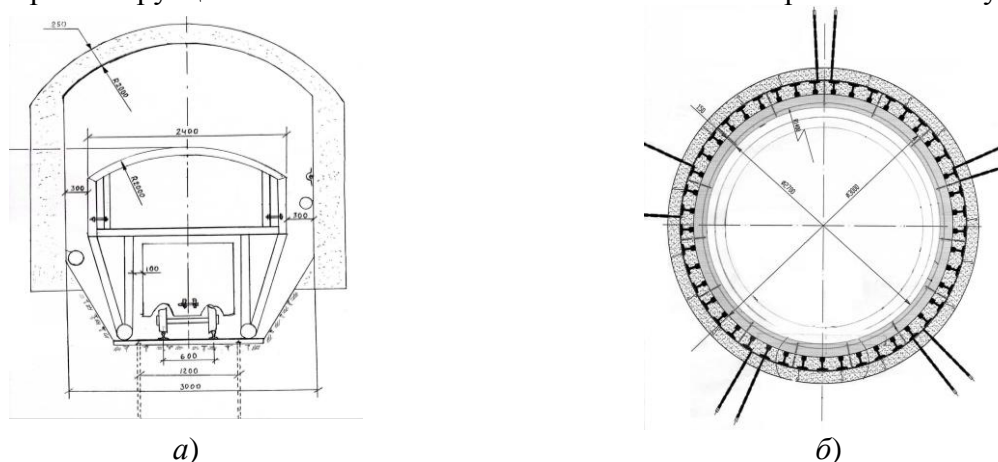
Поперечные сечения в период реконструкции: а – рудоспуска №3, б – рудоспуска №4
